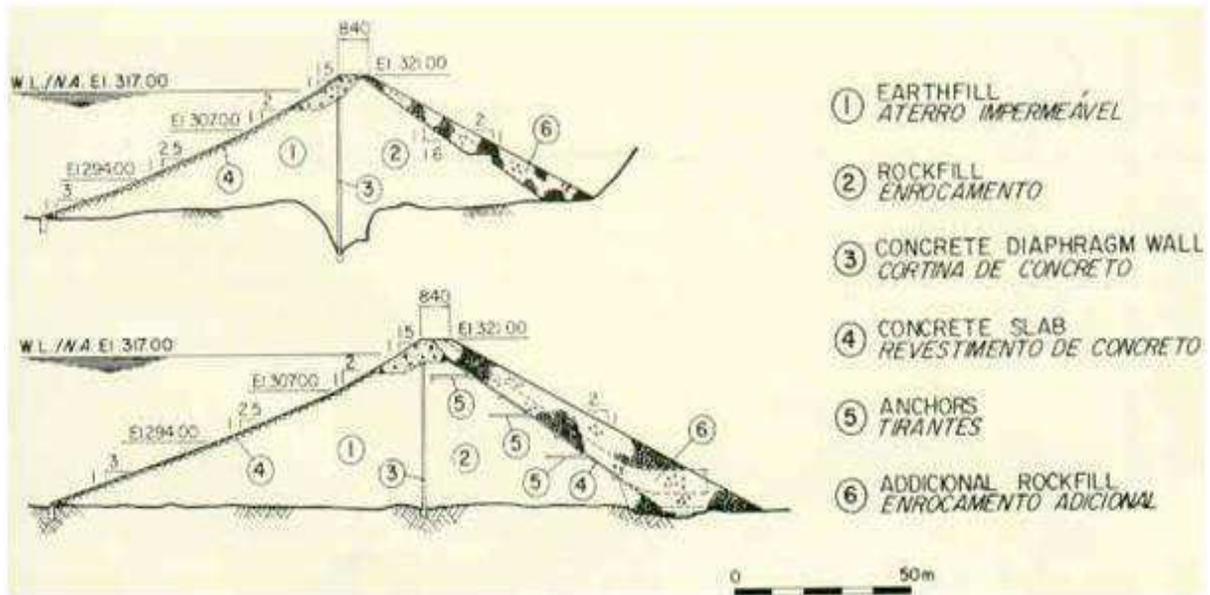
Plante da reforma, em corte transversal, da alteração do projeto de construção de Engenheiro Ávidos (Fonte: DNOCS, 1976)
